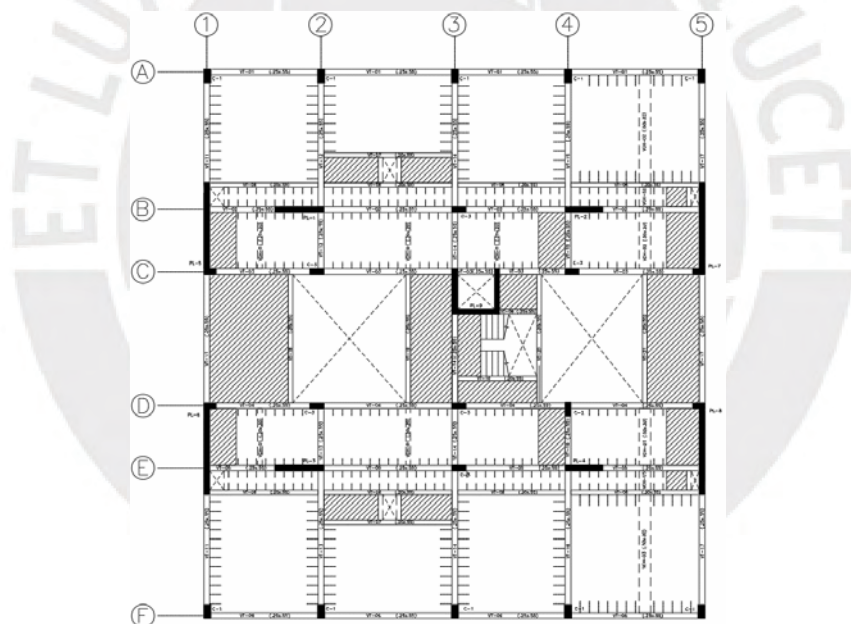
Estructuración de planta típica del sistema de muros estructurales
